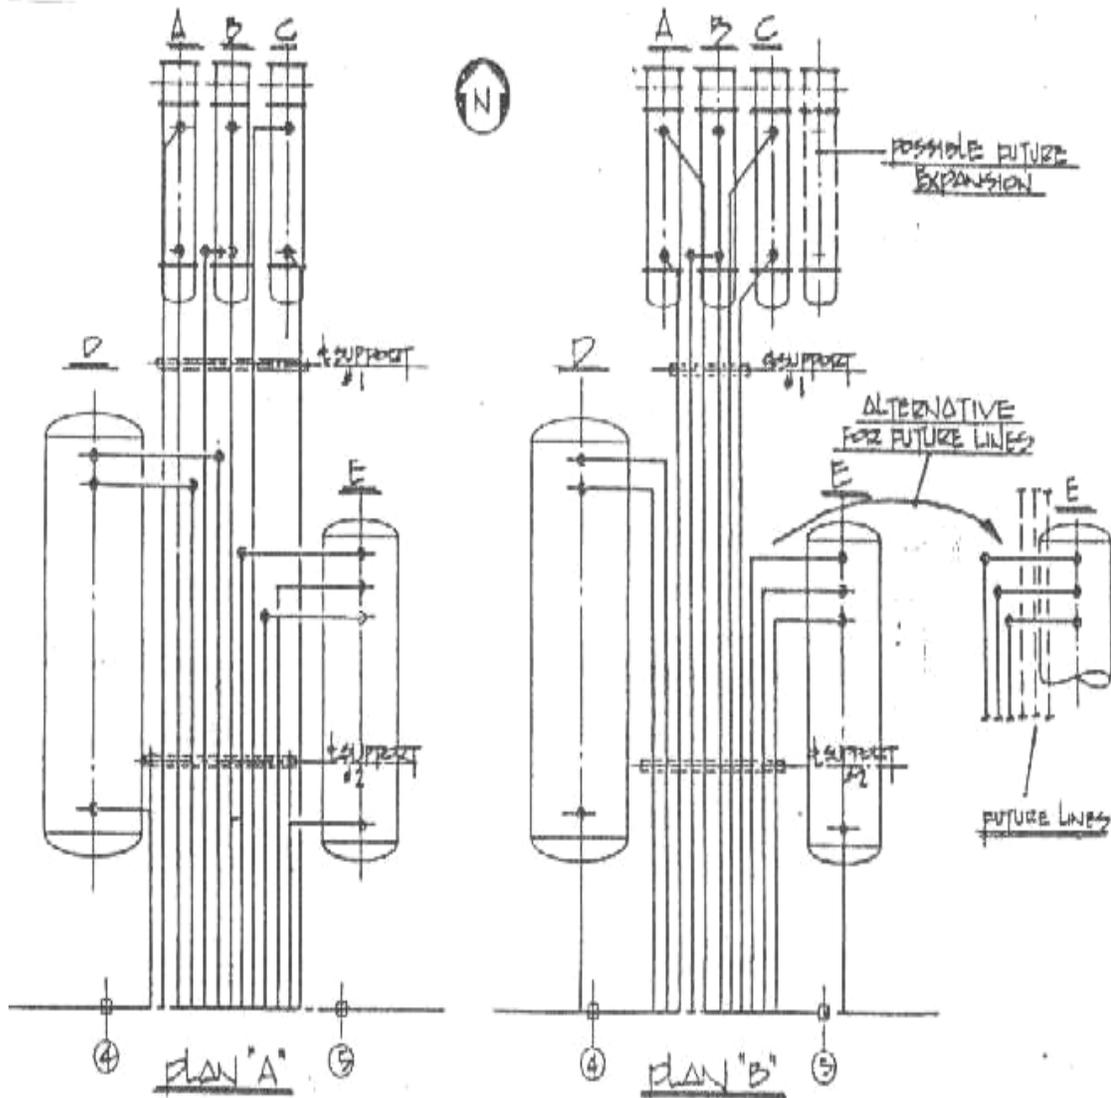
Vista o representación de un trabajo de *Layout* para conexión entre tuberías y equipos.
